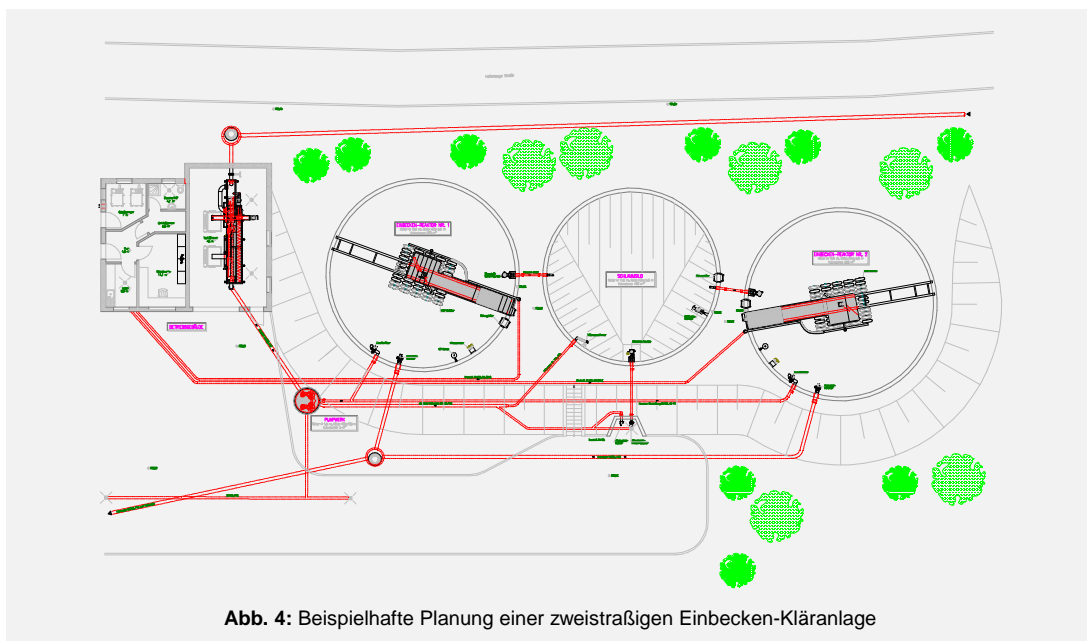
Beispielhafte Planung einer zweistraßigen Einbecken-Kläranlage
